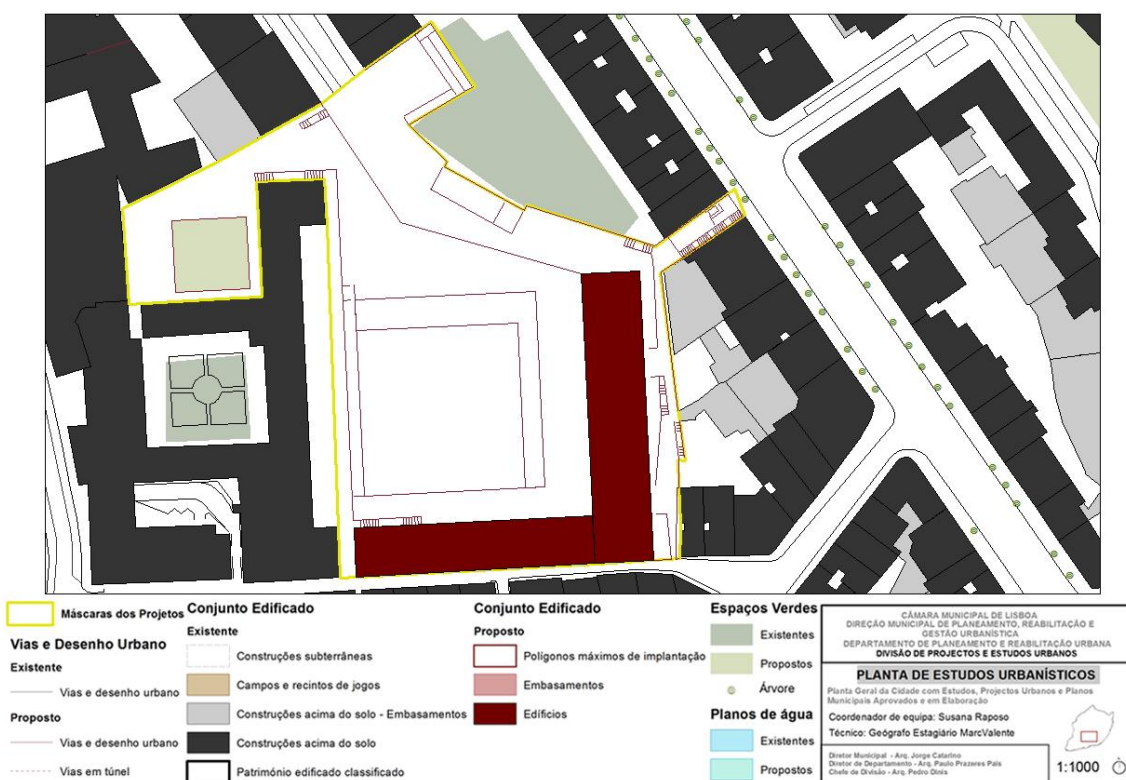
Plano enquadrado na Planta de Estudos Urbanísticos (pormenor)
